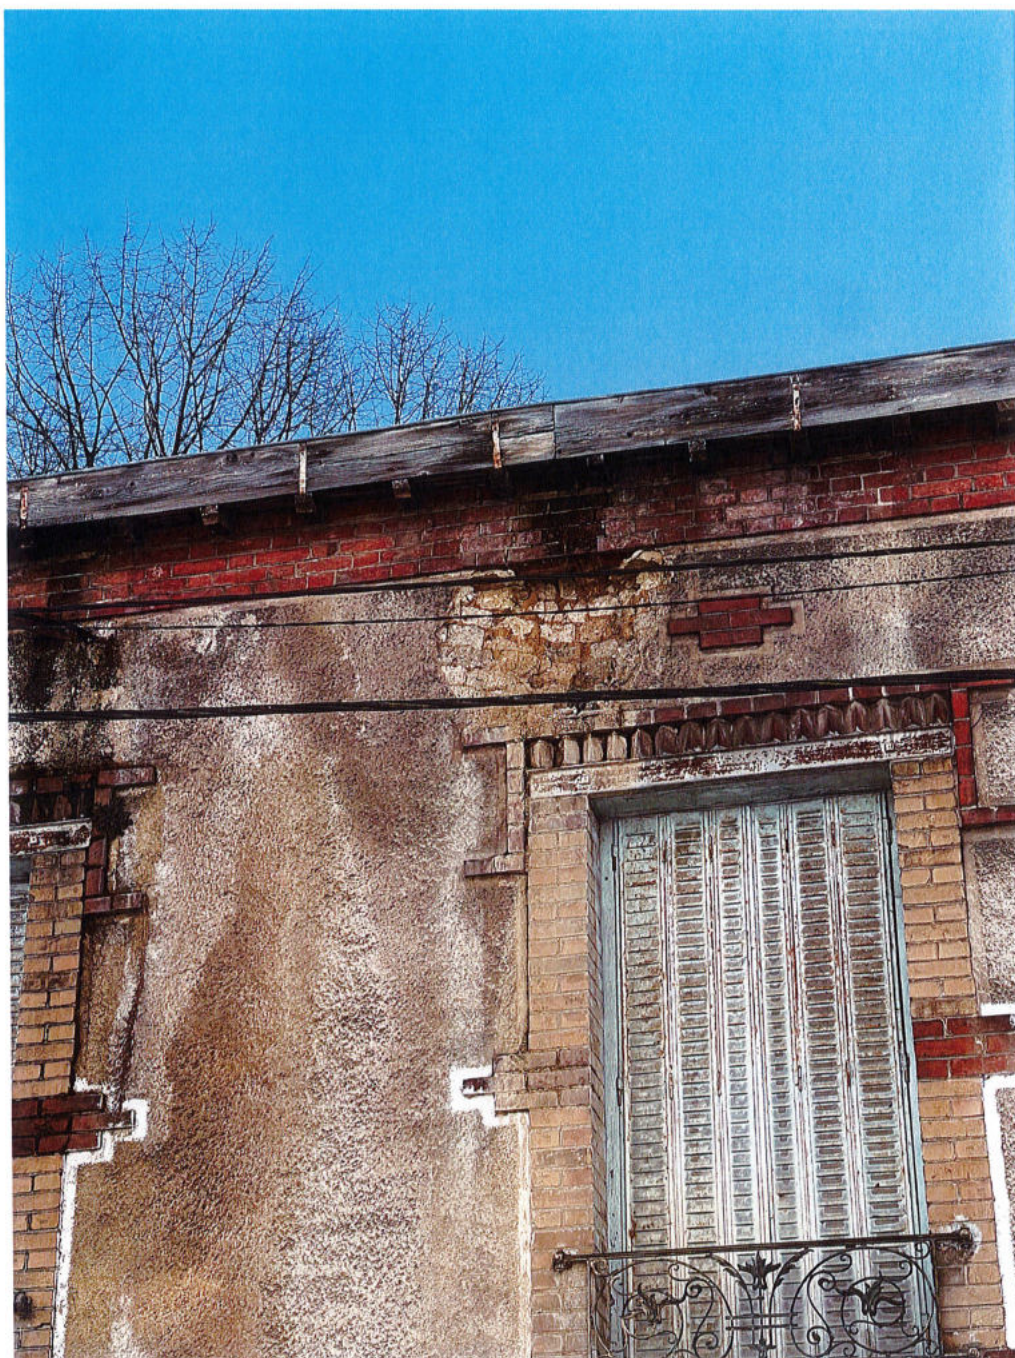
Façade avant –vue détaillée sur les désordres en façade
